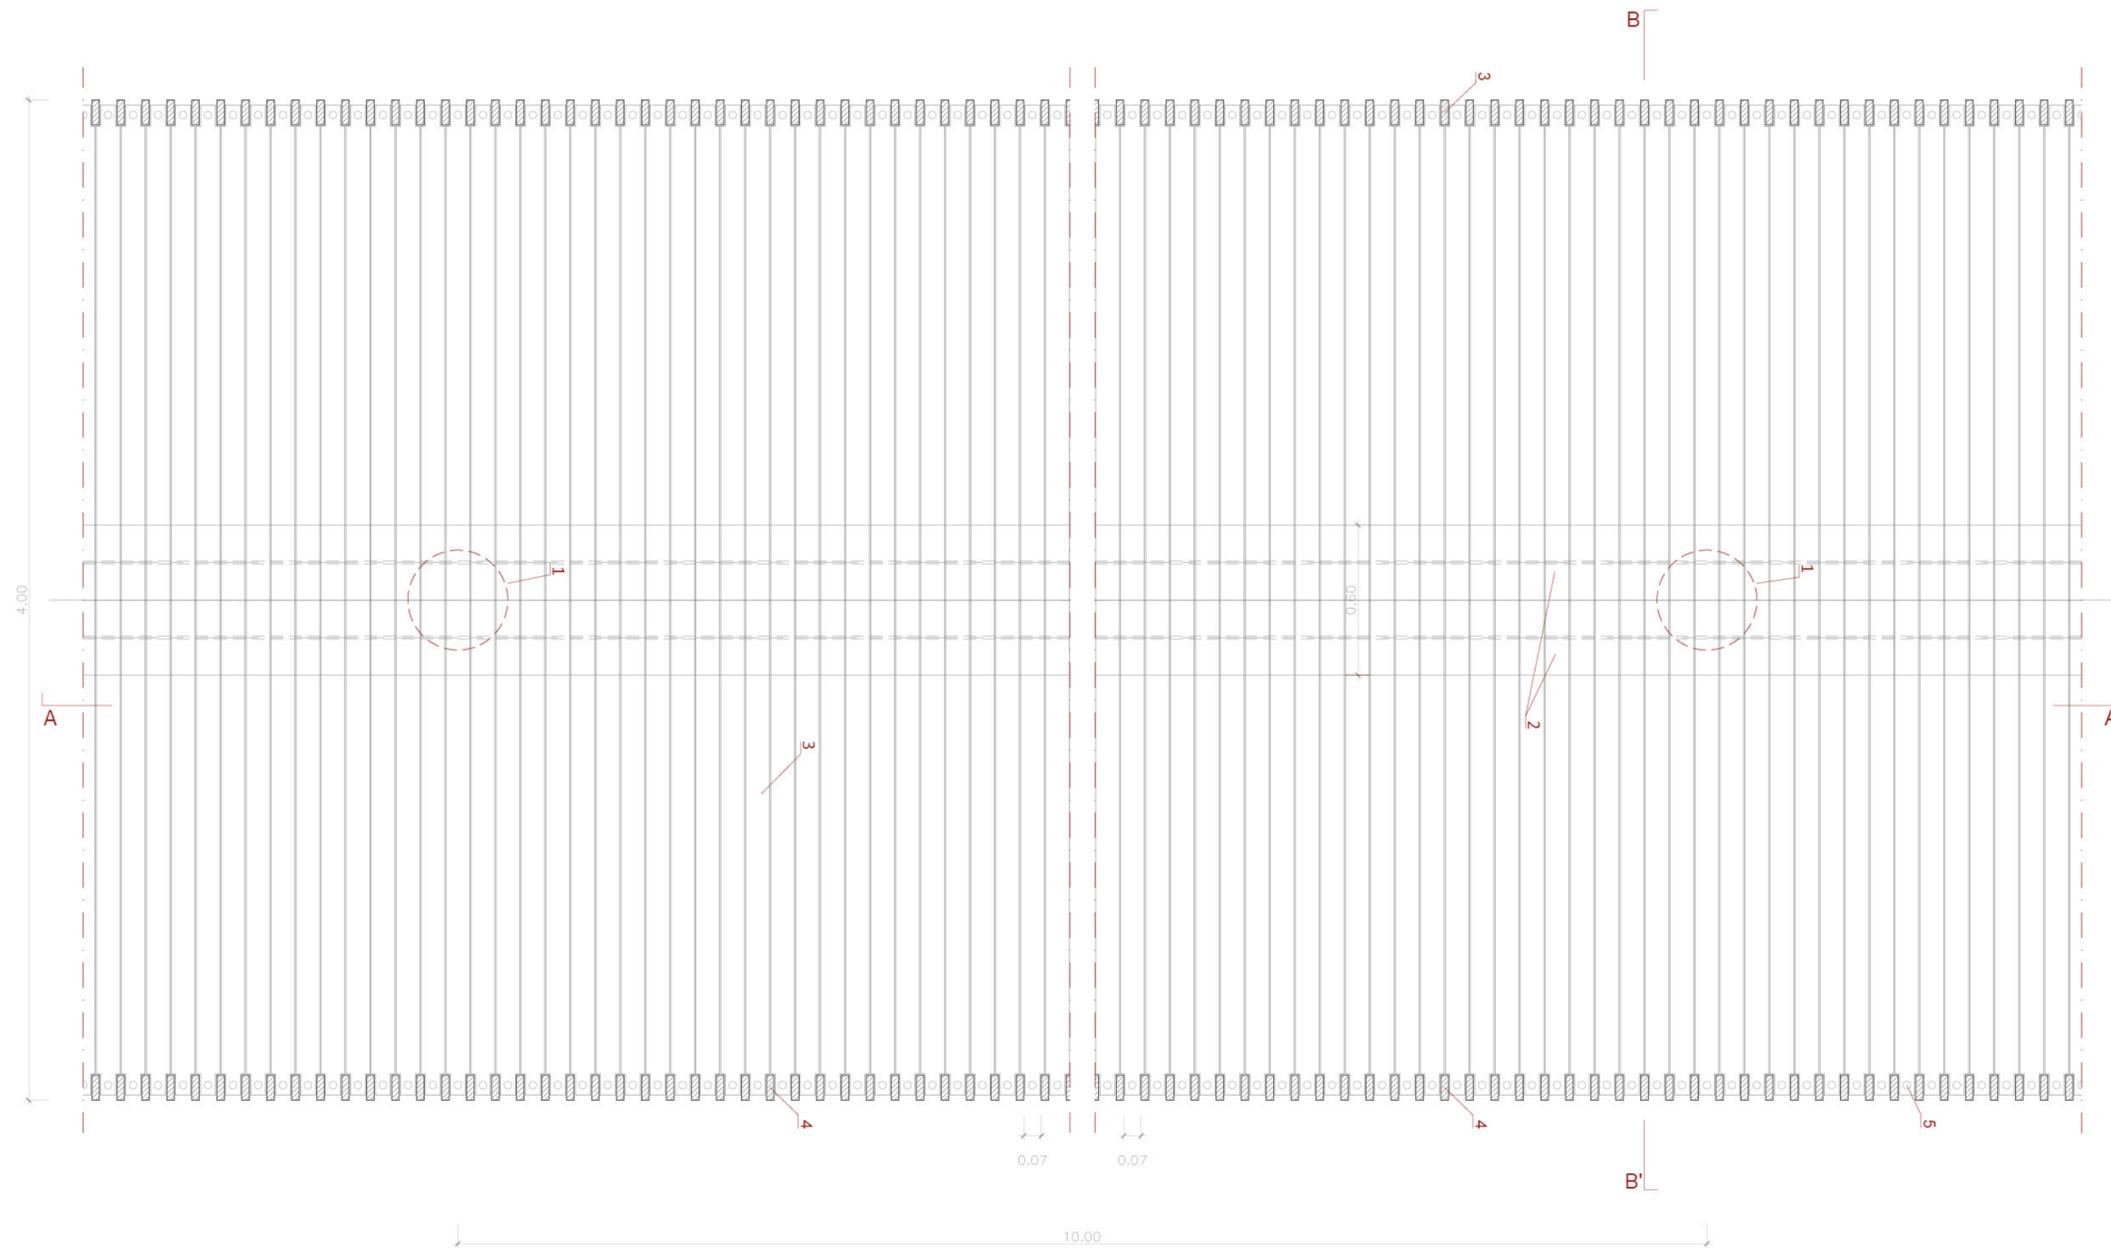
ALÇADO PORMENOR ELEVACÃO PASSADIÇO
